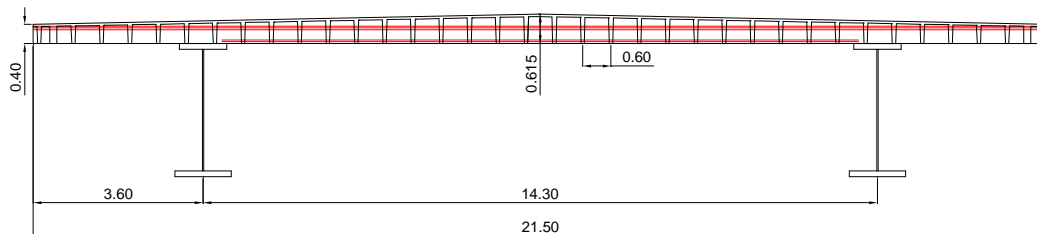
Ouvrage S460/S690 : profil en travers
